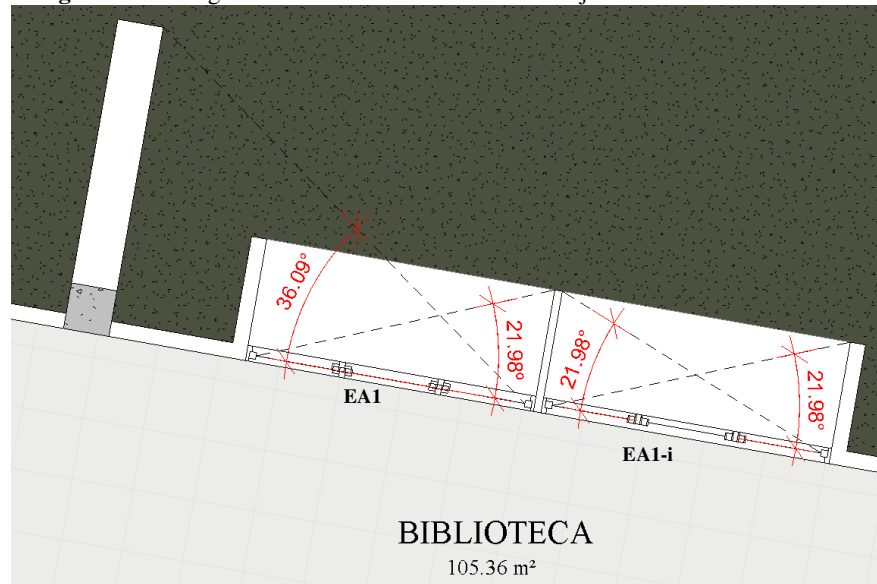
Ângulo horizontal de sombreamento da janela EA1-i e EA1-ii na fachada norte
